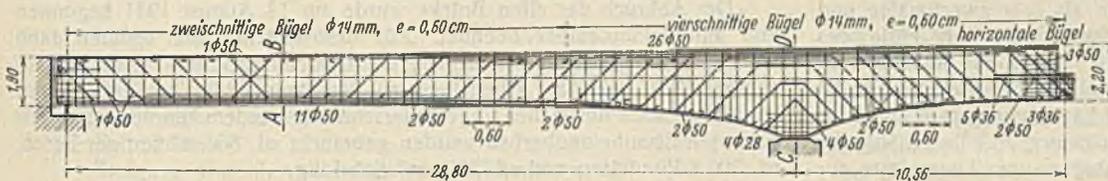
Bewehrung des Trägers der Seitenöffnung mit Kragarm.
